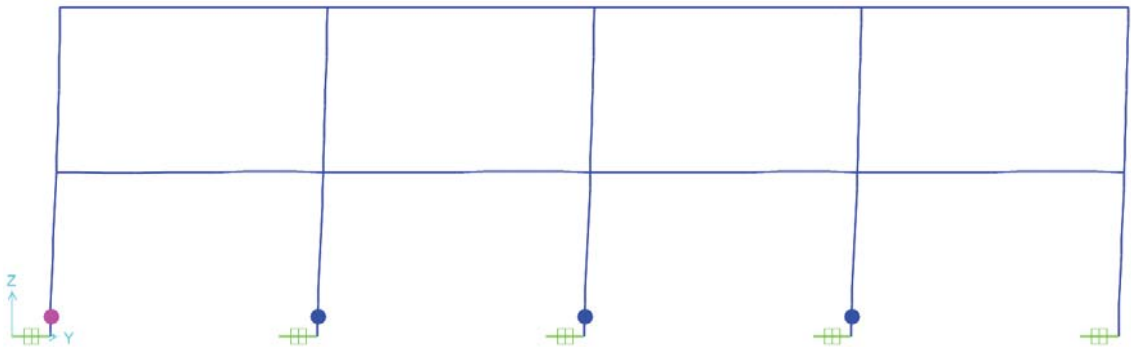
Secciones de columna en estado de Ocupación Inmediata – Aislado
